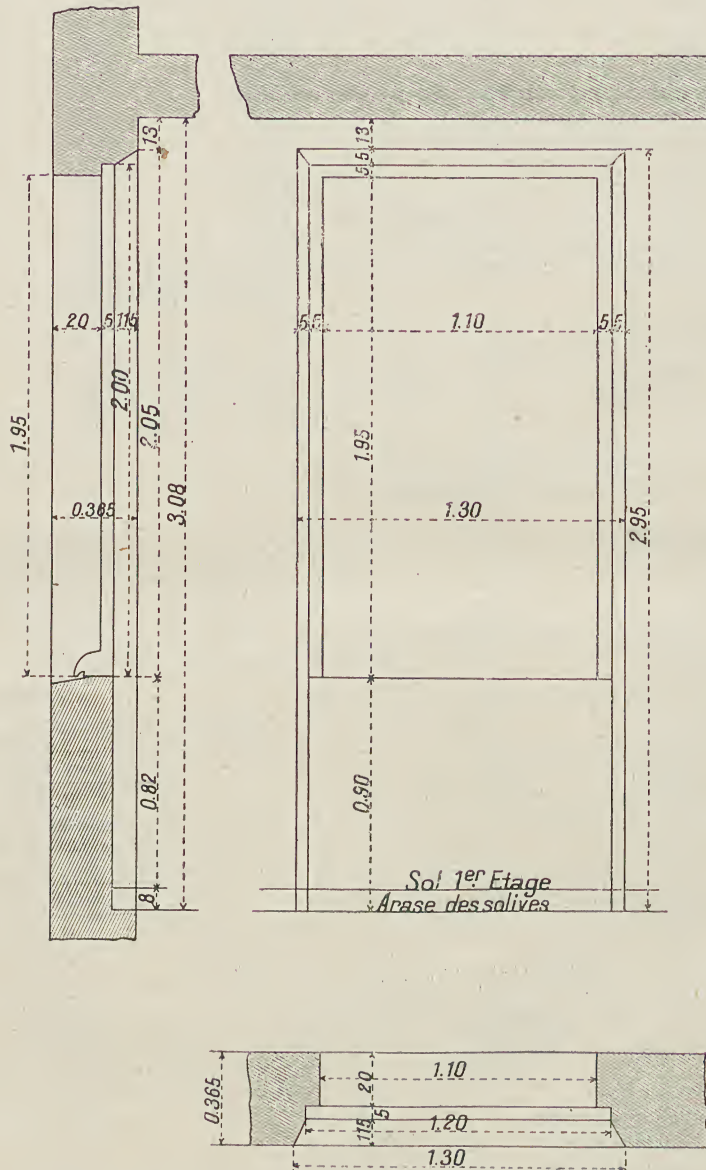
à 708. — Coupe, élévation intérieure et plan.
